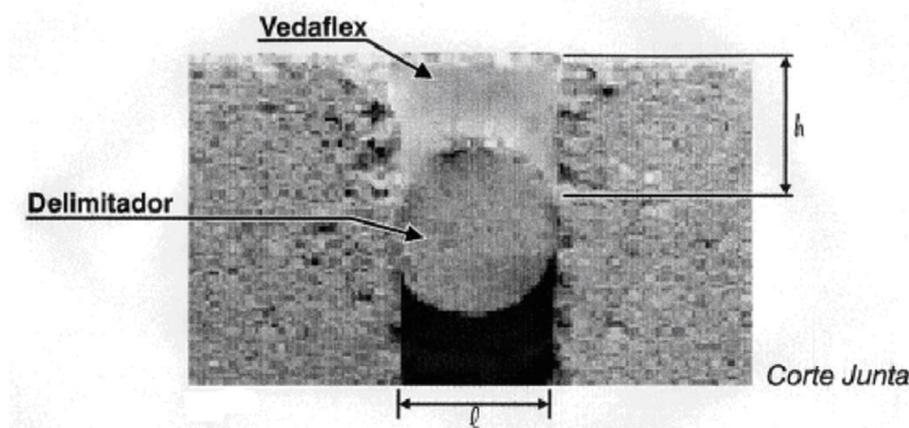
Selagem de fissura (Vedacit, 2006)
